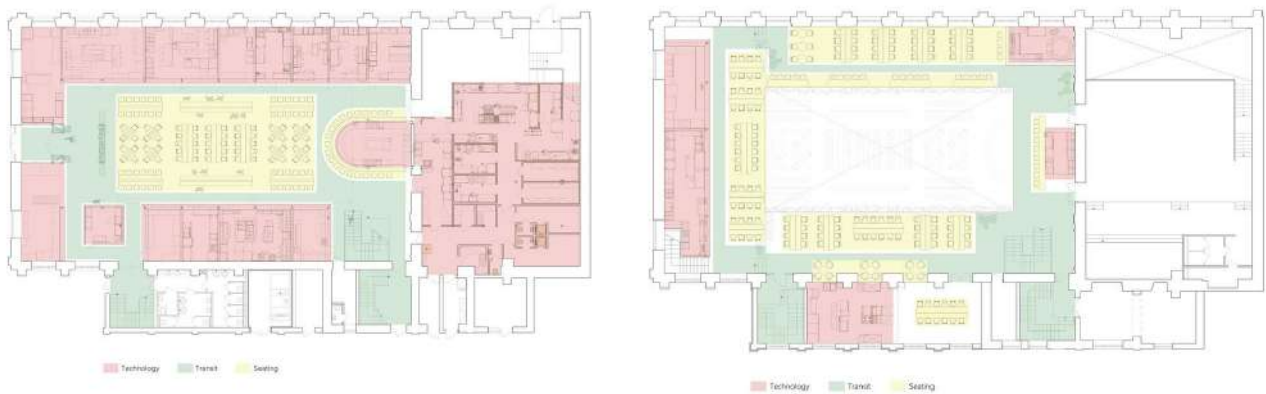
План 1-го та 2-го поверхів Kyiv Food Market [18].
